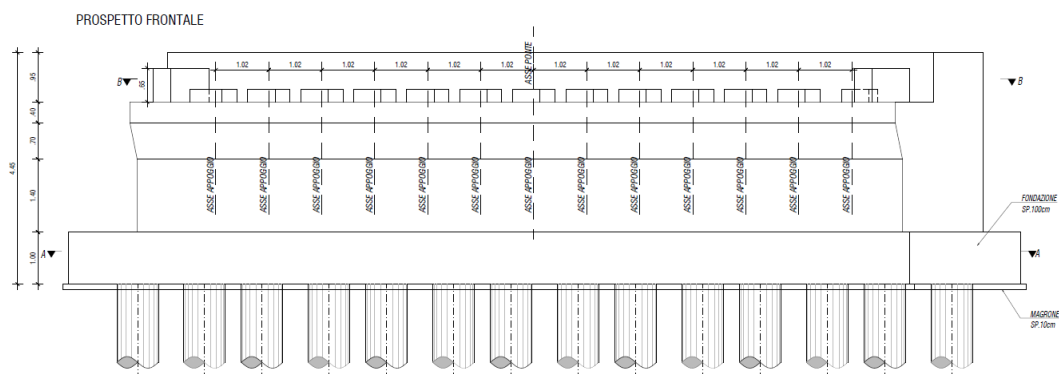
Prospetto frontale di carpenteria spalla.
